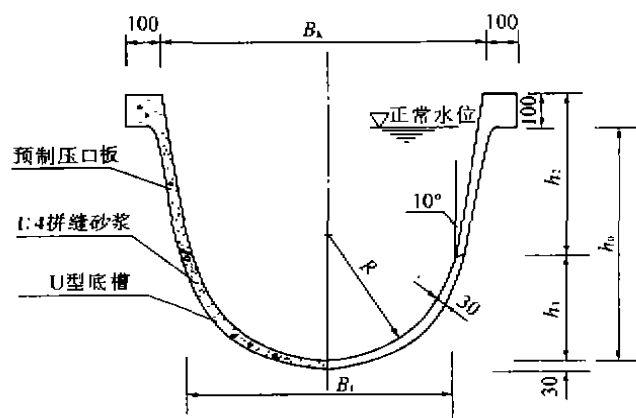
拼装式混凝土 U 型预制渠槽示意图(单位:mm)
